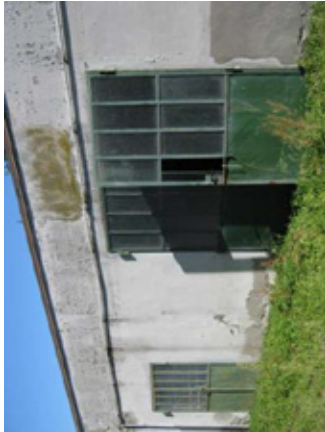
Fabbricato B - cantina e ricovero attrezzi. Piccolo edificio costruito in muratura di mattoni con copertura piana in laterocemento, della superficie lorda complessiva di circa 75,00 mq, disposto sul solo piano terra e suddiviso in due locali.
